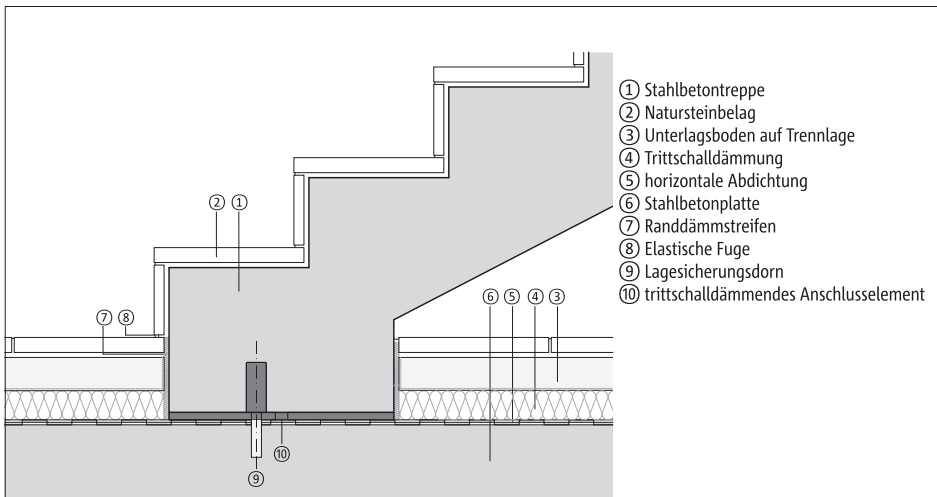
Beispielhaftes Anschlussdetail – Treppenlauf an Bodenplatte mit Lagesicherungsborn
